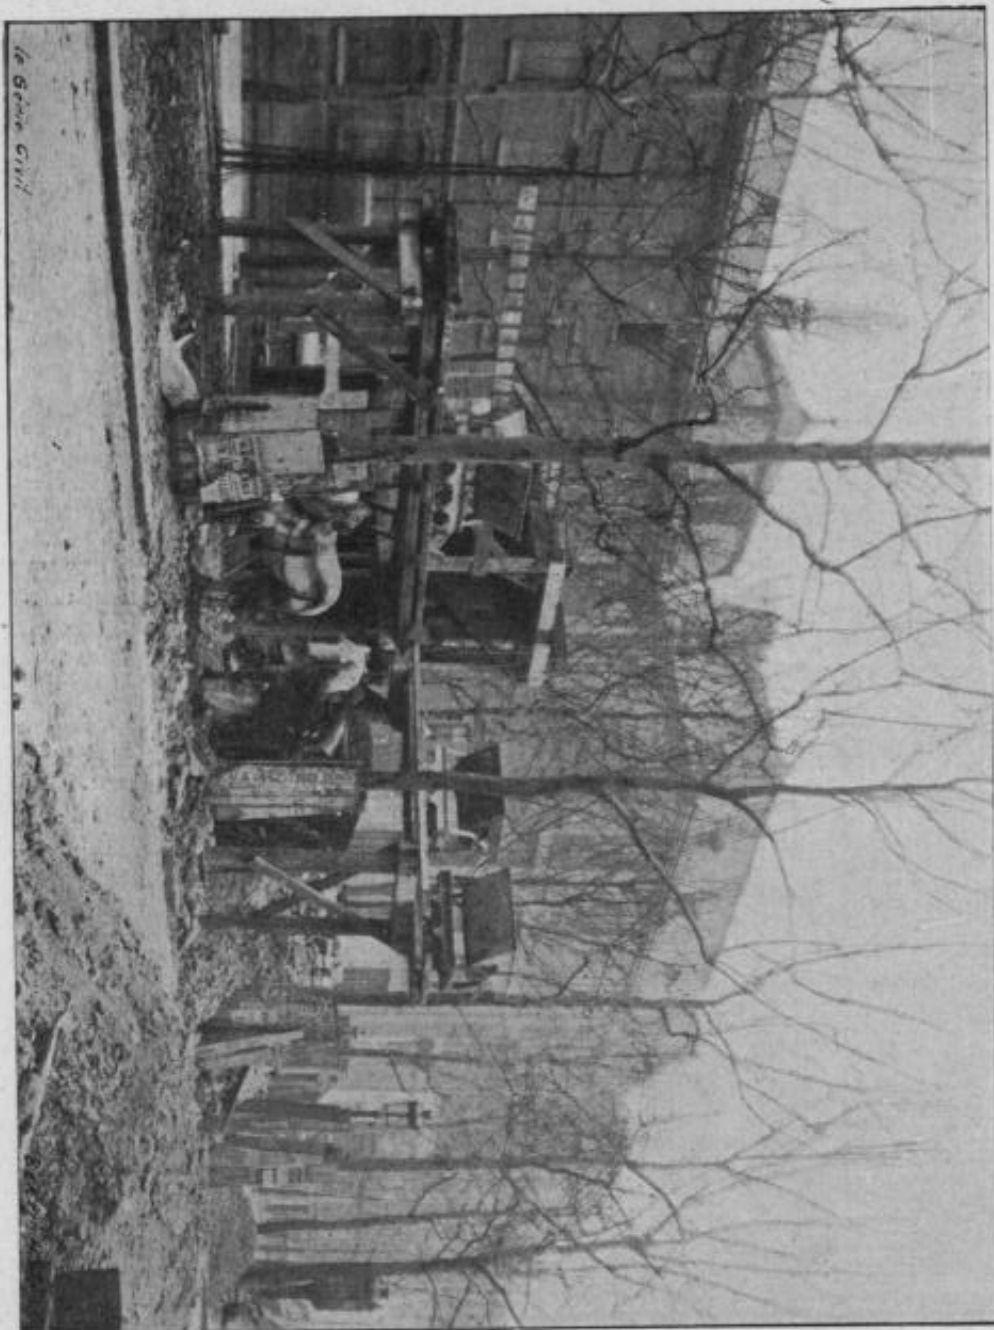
Construction de la ligne B : Chantier situé boulevard de Rochechouart, devant le collège Rollin
